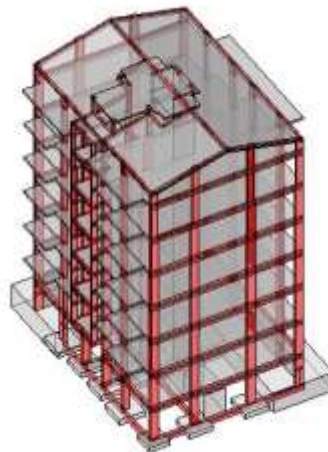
Vista alçado lateral direito projeto 3D laje vigada
